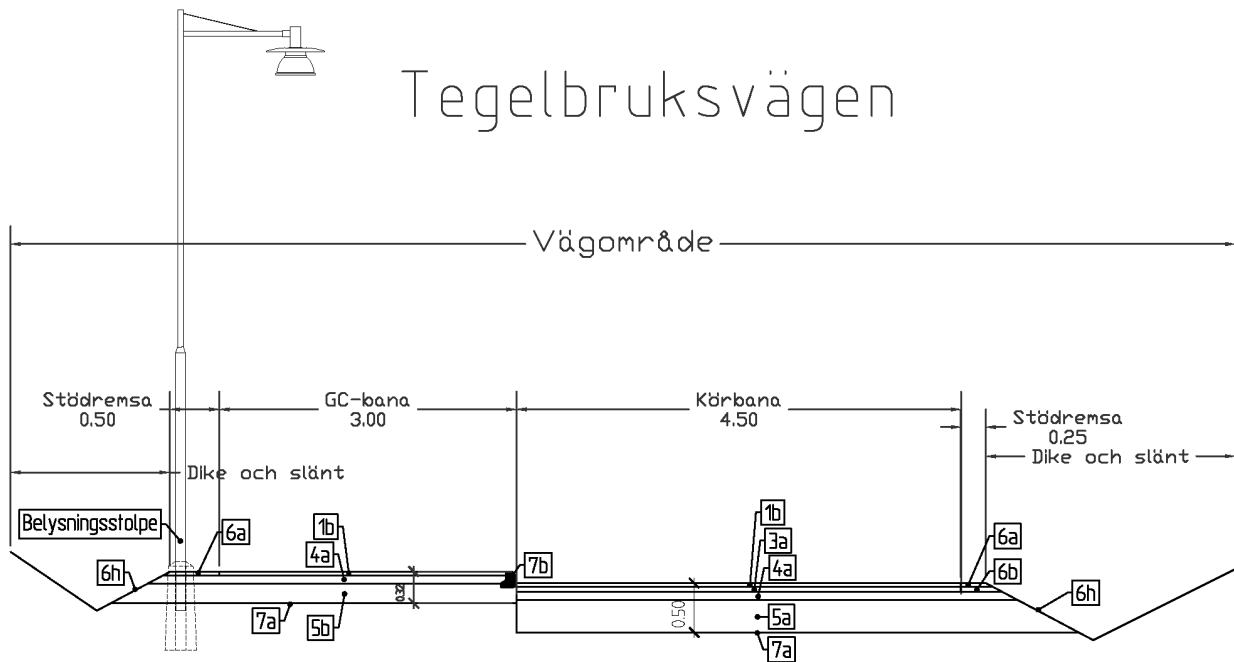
Typsektion för Tegelbruksvägen. Se bilaga 4 för teckenförklaring.
